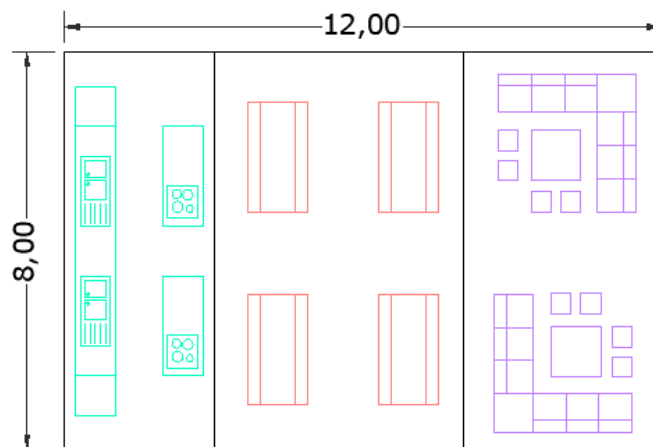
Proposta de distribució de l'espai en planta (dimensions en metres)
